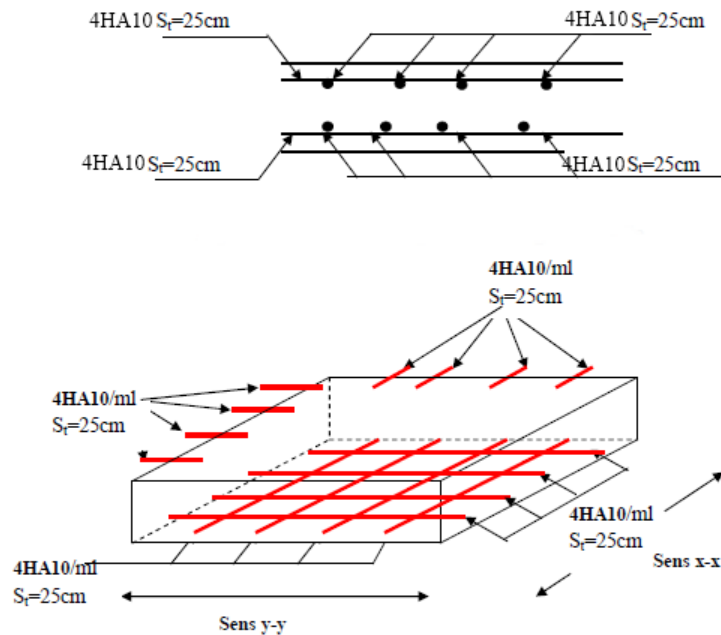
Dessin de ferrailage de la dalle d'ascenseur
